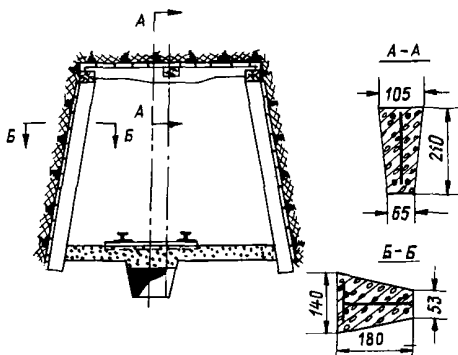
Железобетонная трапециевидная жесткая крепь
